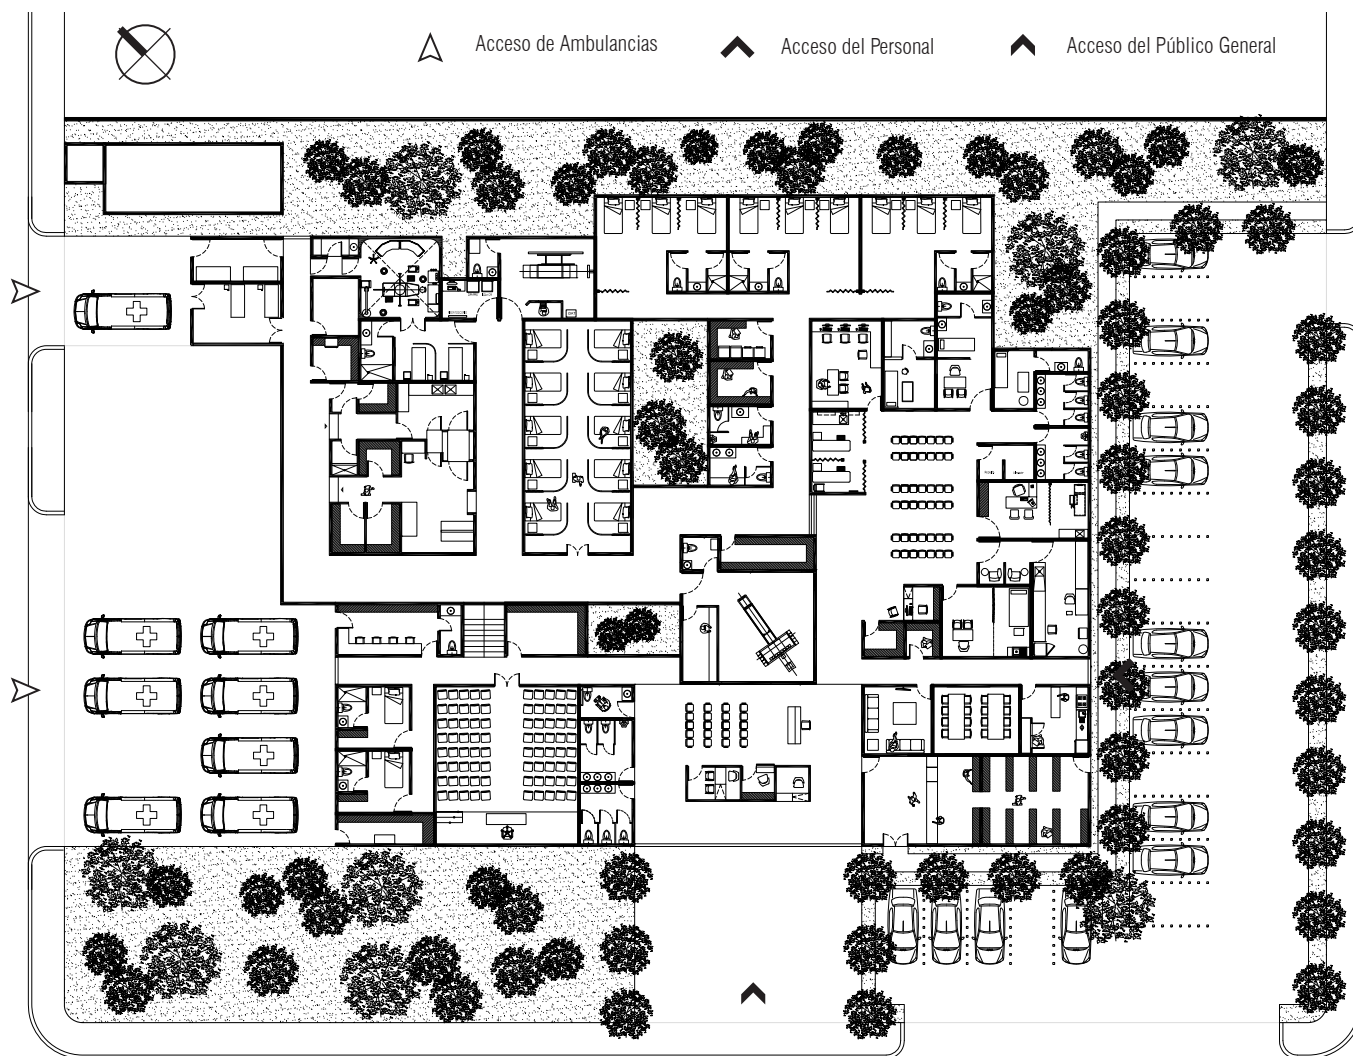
| Prototipo Delegación Completa para el grupo climático uno | Planta Baja
